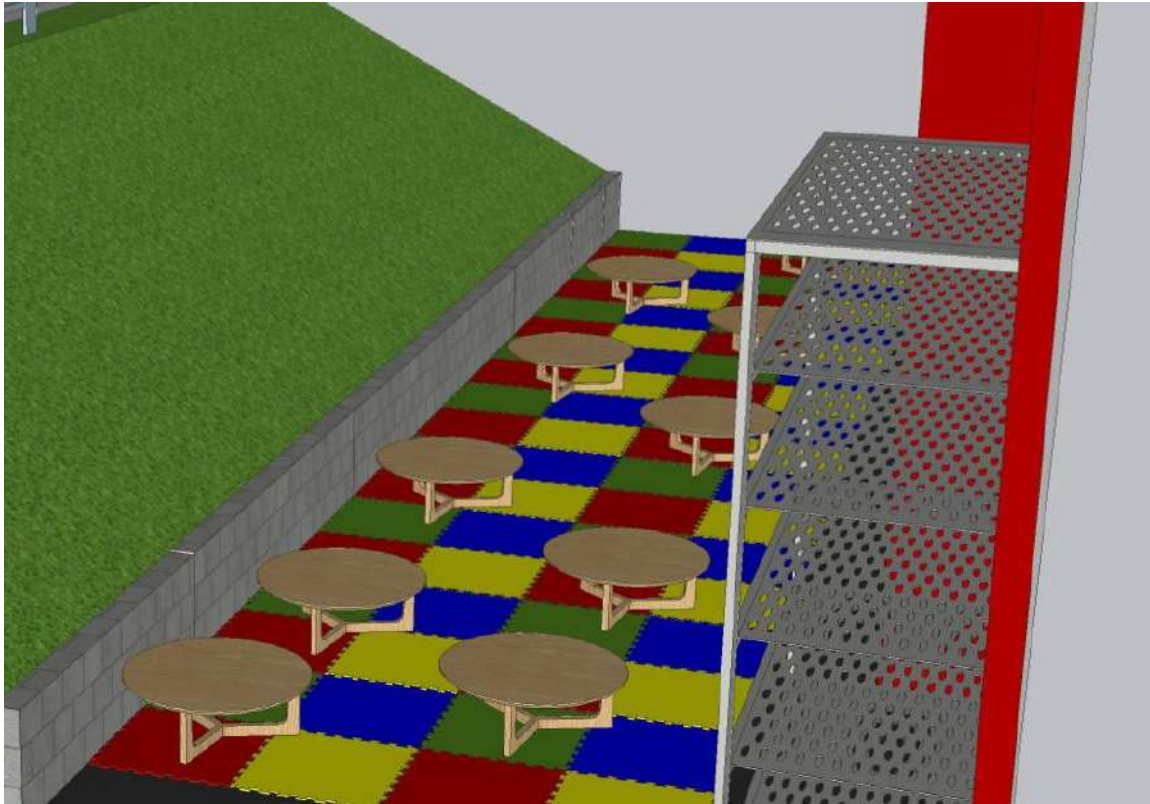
Planta 3D – Entrada ao Yin Yang
